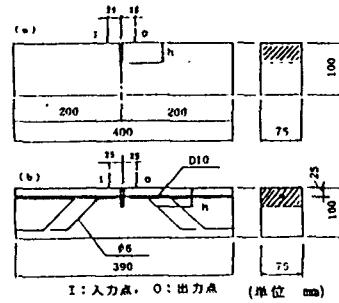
供試体の形状寸法、および人工ひびわれ配置状況
